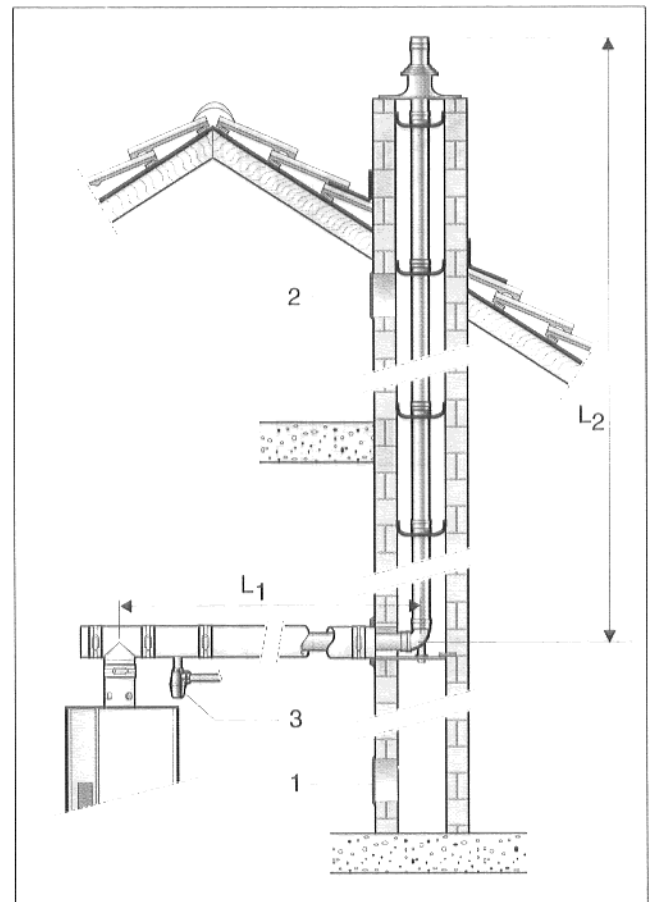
Grundbausatz GA-K für GB112 W/WT und Linea, Abgasführung mit Aluminium-Rohren
